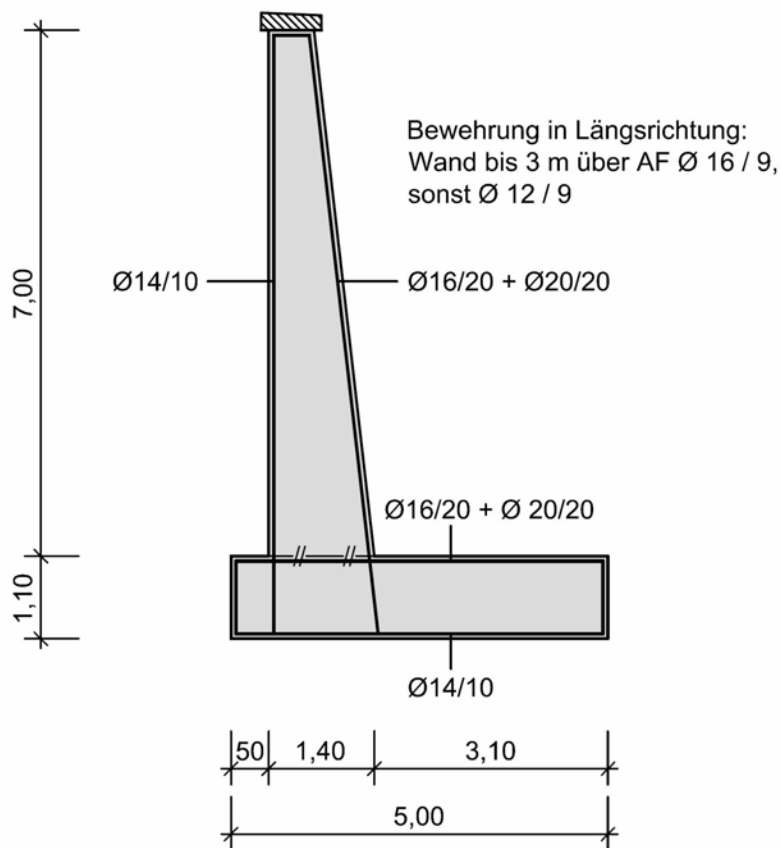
Bauteilabmessungen und erforderliche Bewehrungsquerschnitte
